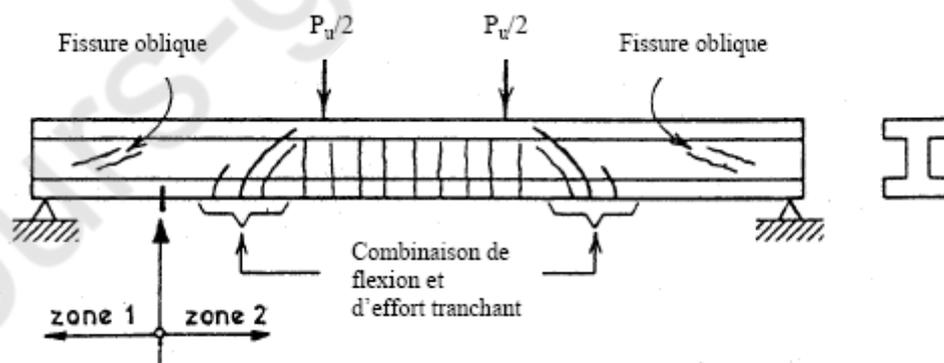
Zones de fissuration et mode de fissuration dans un élément en béton armé et précontraint
